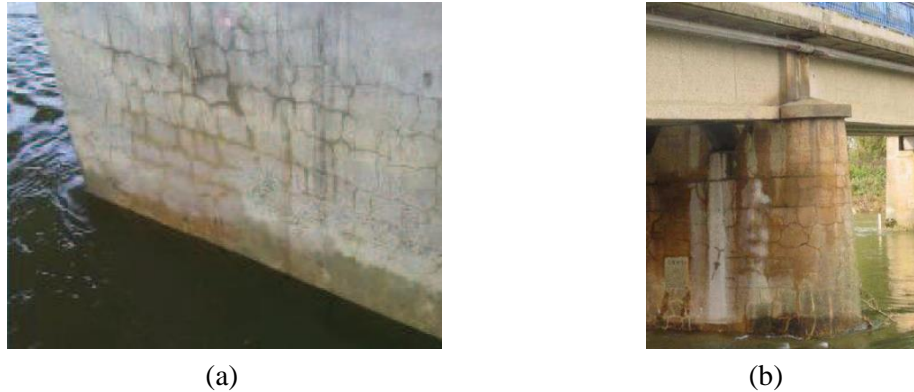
(a) Pile 6 du pont de Bellevue présentant un réseau de fissures dans la zone de marnage ; (b) Zone de fissuration d'une pile du Chevêtre sur pile Pont d'ondes [89].
